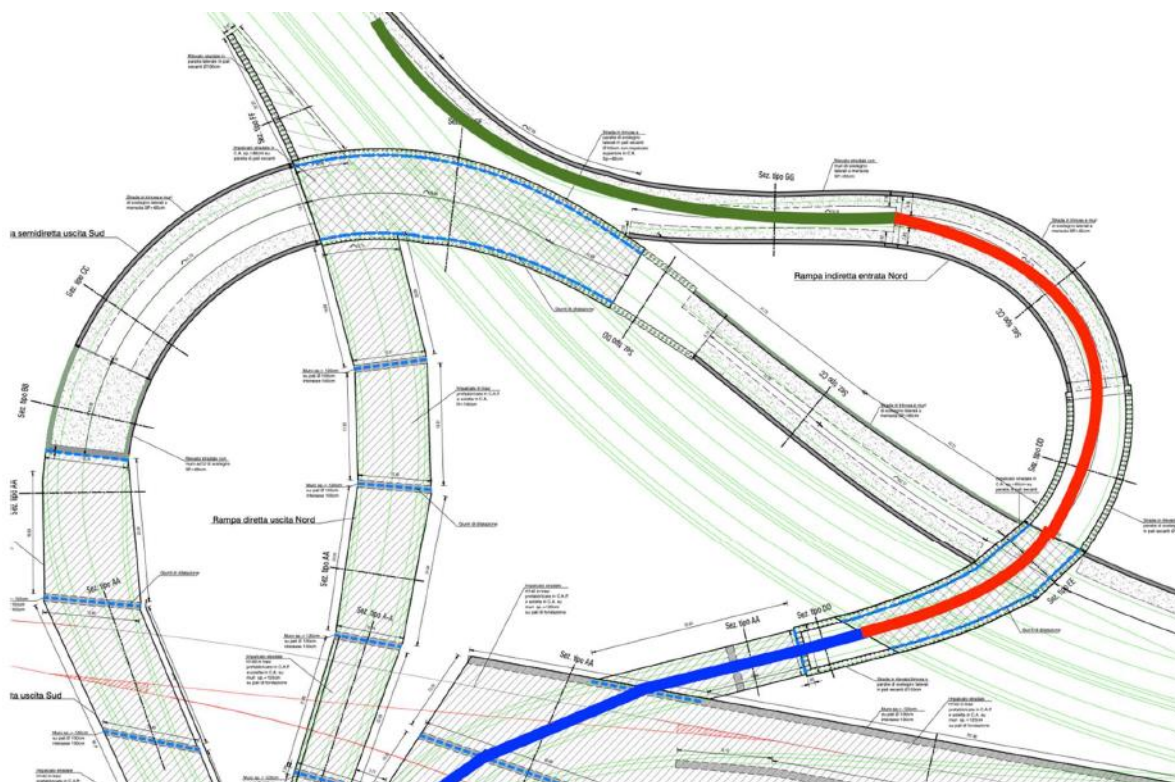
planimetria con evidenziata la rampa indiretta in entrata Nord
